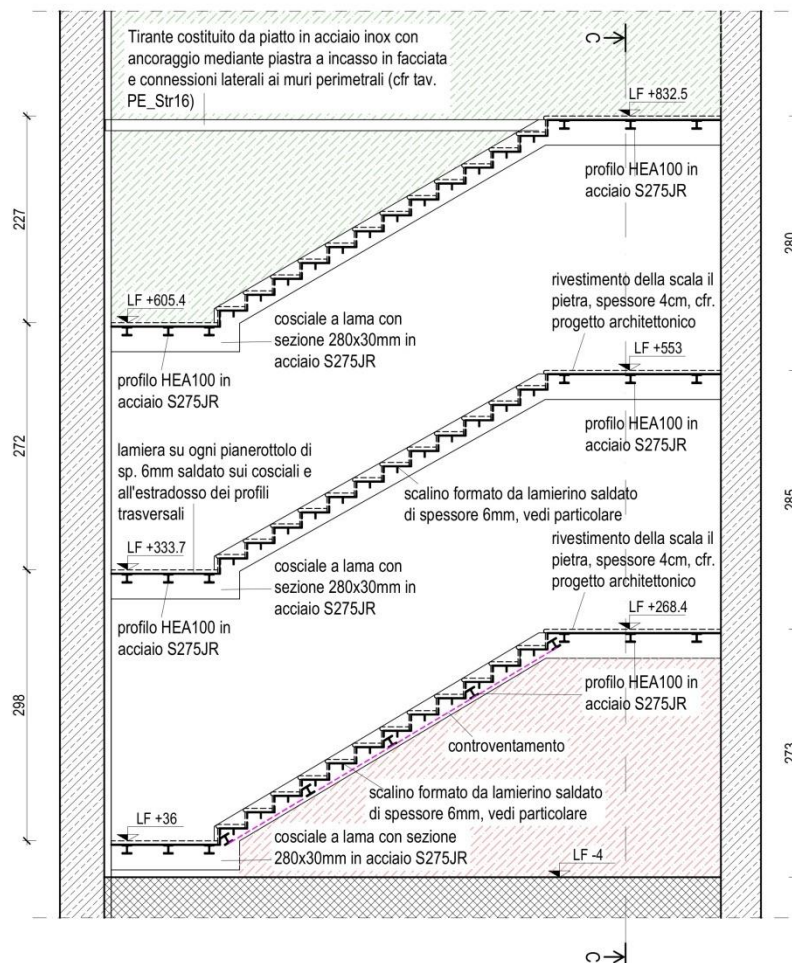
Sezione vano scale con localizzazione degli elementi strutturali
